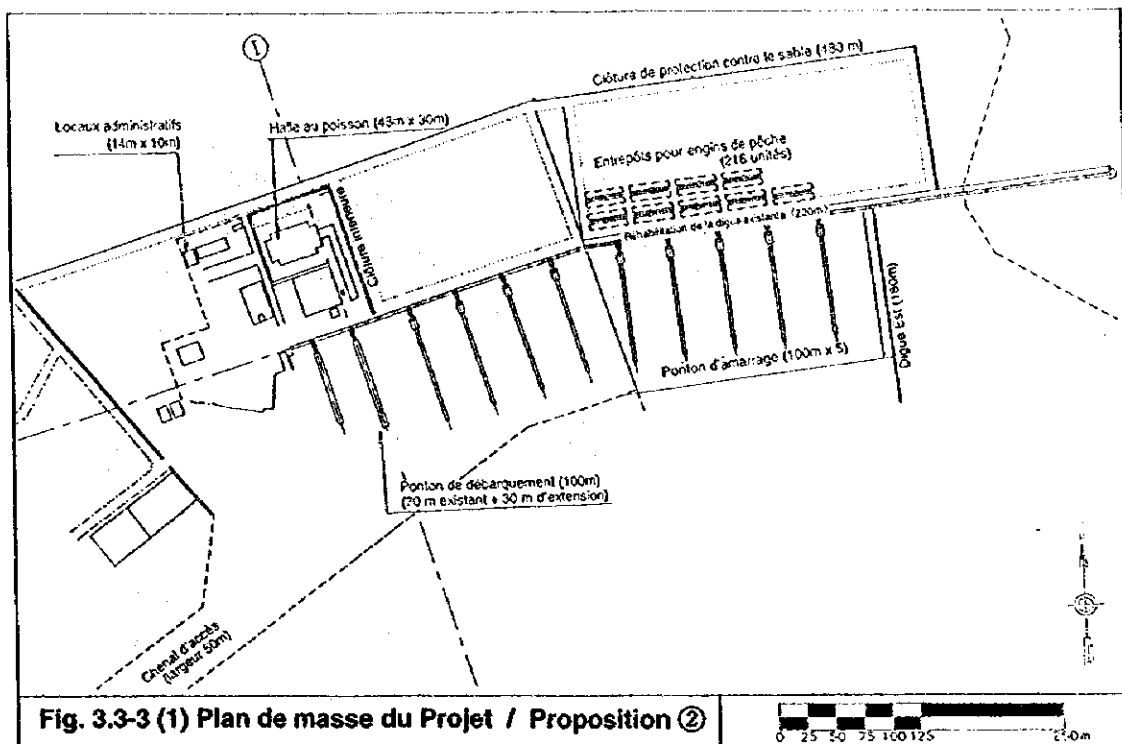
(1) Plan de masse du Projet / Proposition ②
